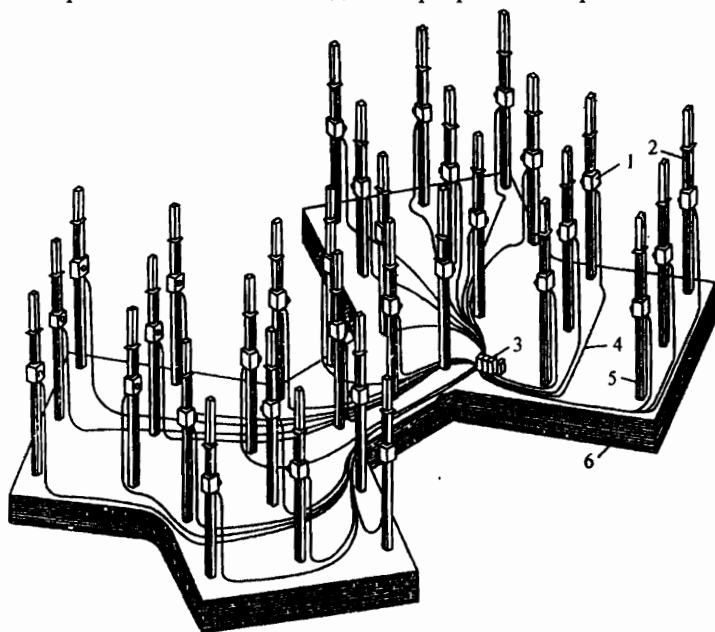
Схема электромеханического подъемного оборудования на строительстве 12-этажного жилого здания: 1 - электромеханический подъемник; 2 - грузовые тяги; 3 - пульт управления; 4 - электрокабель; 5 - колонна; 6 - пакет плит перекрытий
